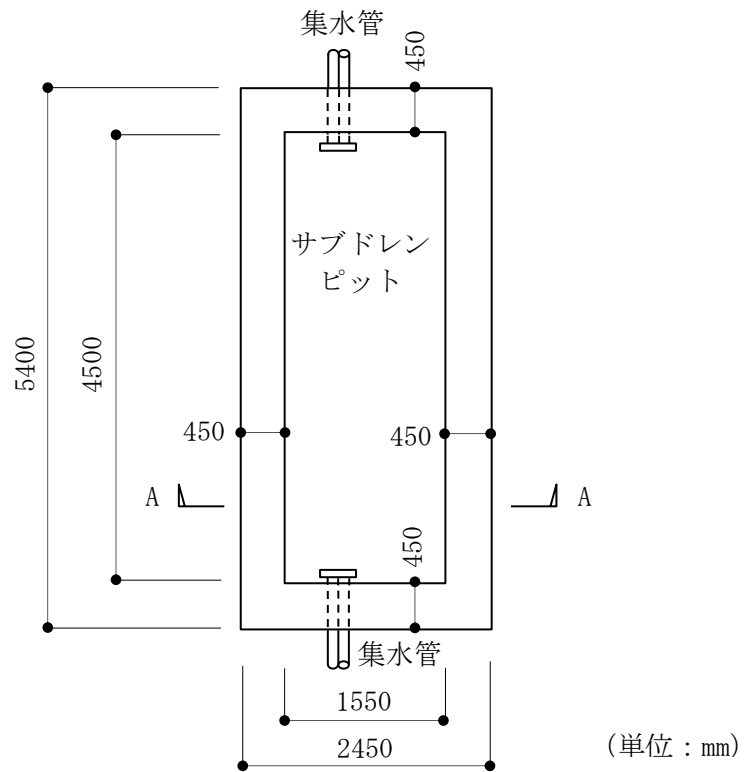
原子炉建屋サブドレンピットの概略平面図 (T. M. S. L. -15. 25m)
